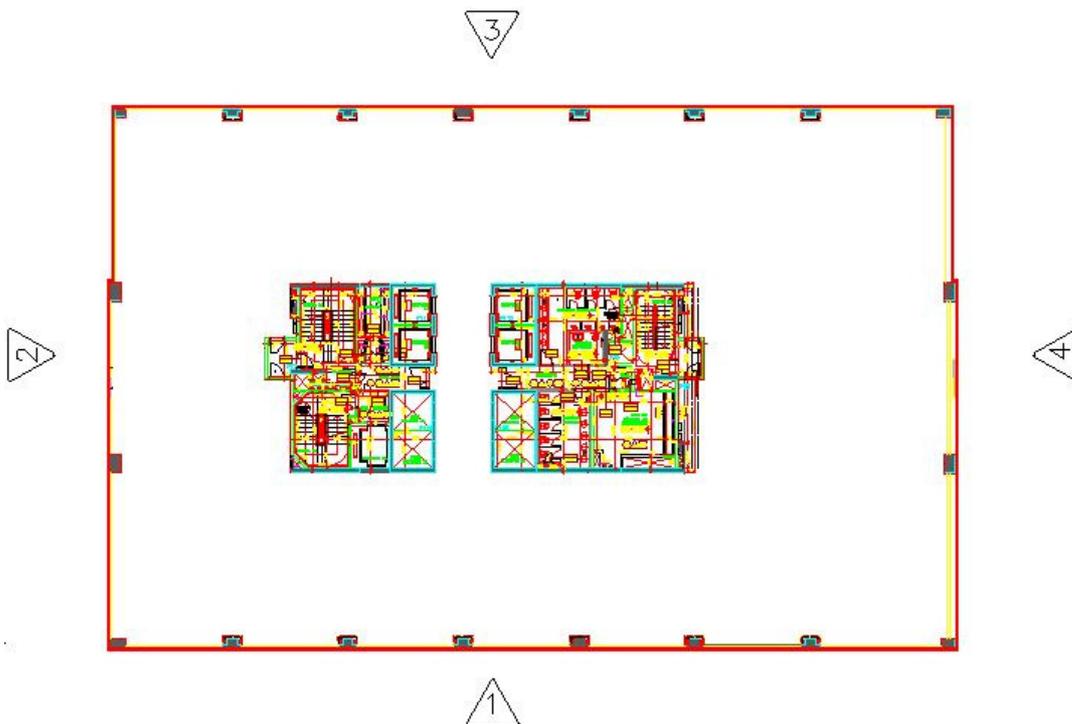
Planta baixa dos edifícios do empreendimento “R” com a numeração das fachadas
